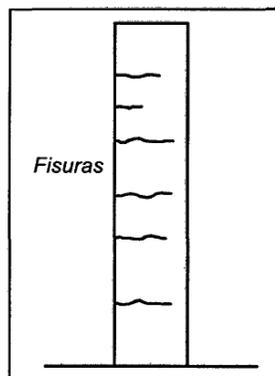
Fisuración transversal en pilares debida al pandeo
